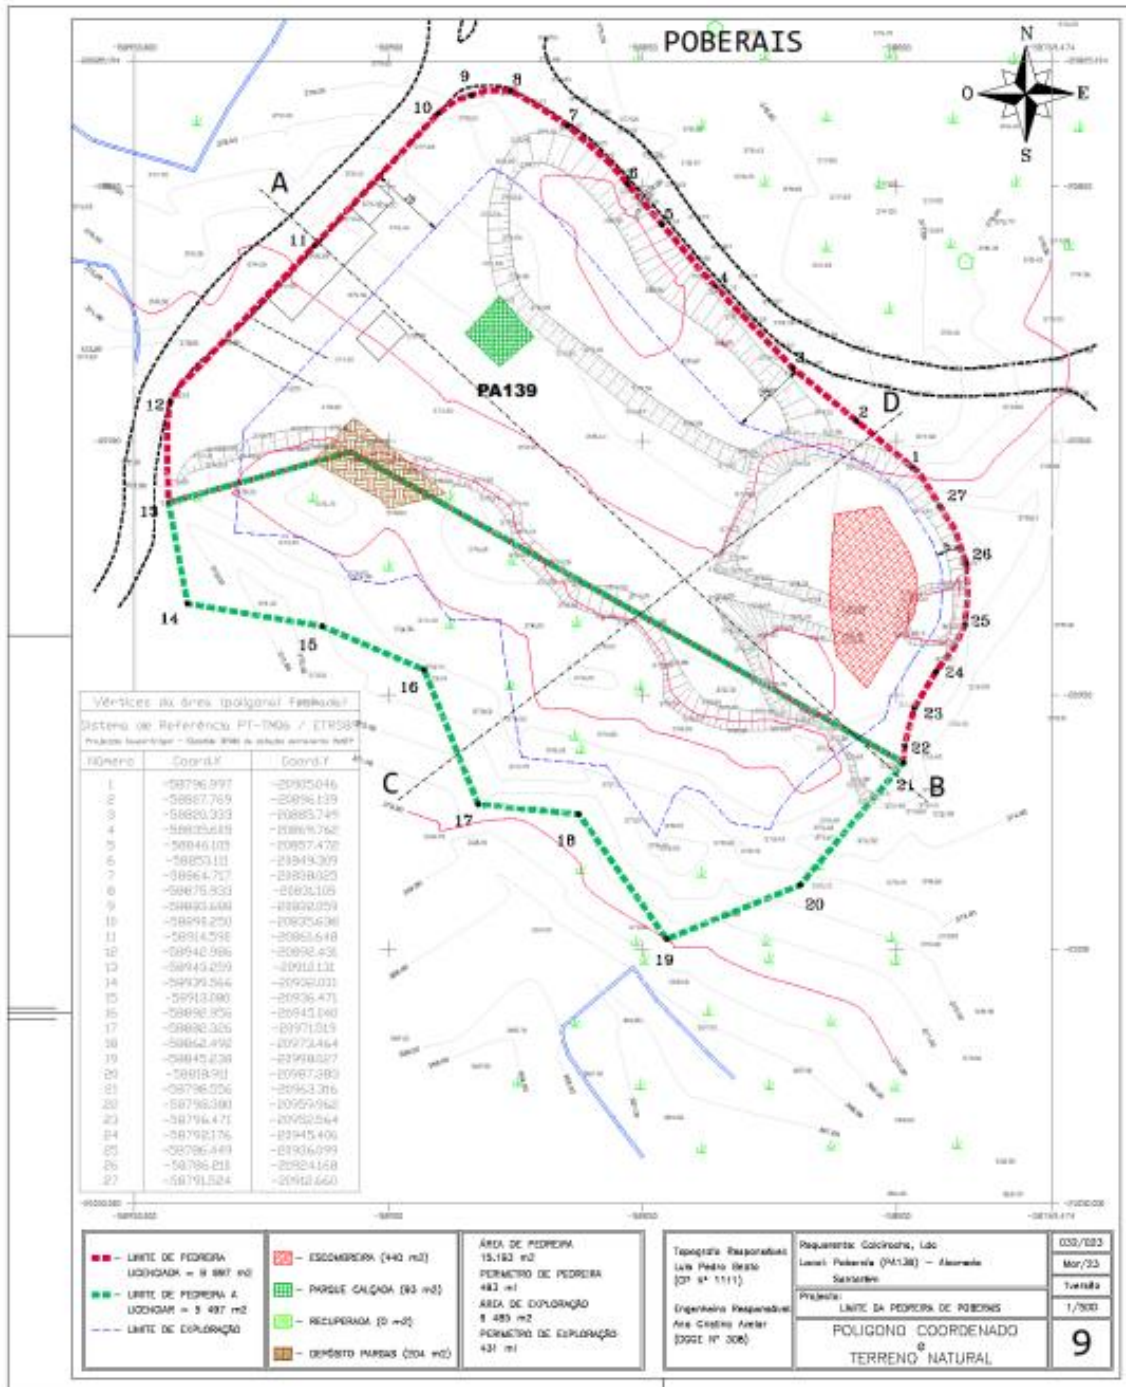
Planta de zonamento da pedreira “Poberais nº 4”.
